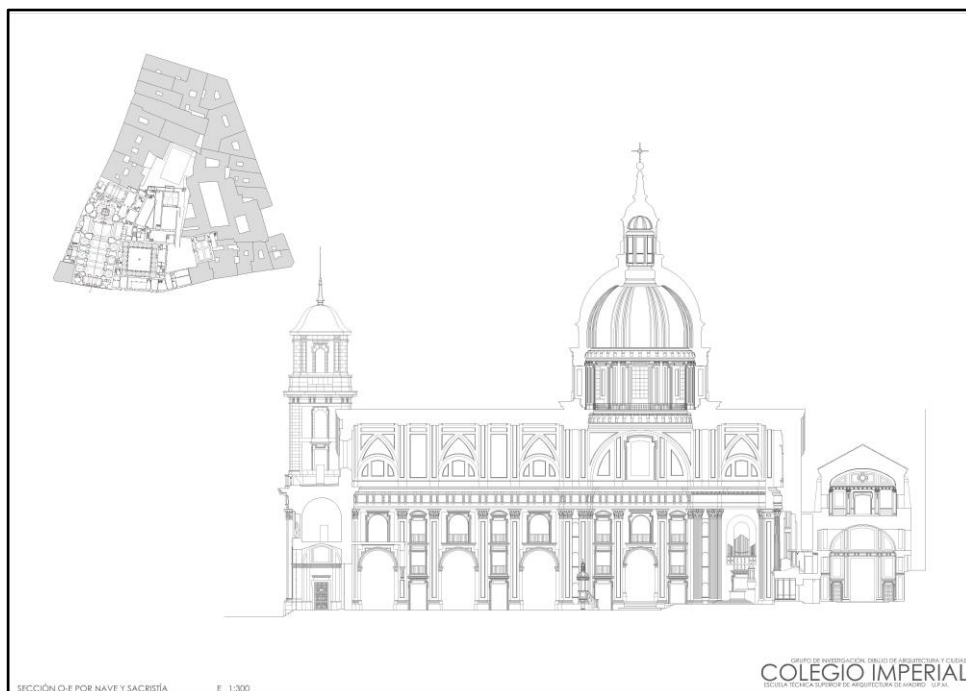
Concatedral de San Isidro: sección y alzado longitudinal por el eje de la iglesia.
